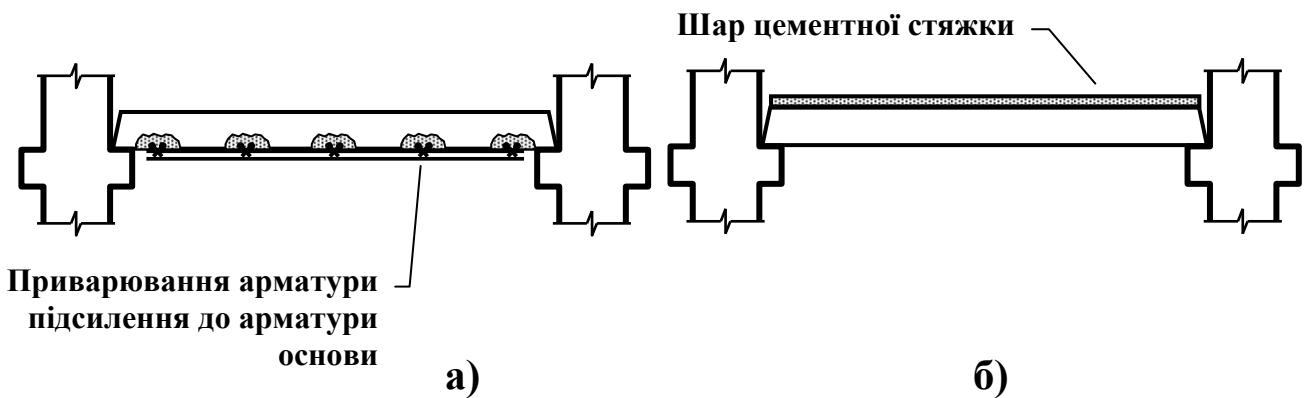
Підсилення залізобетонних плит нарощуванням перетину:
